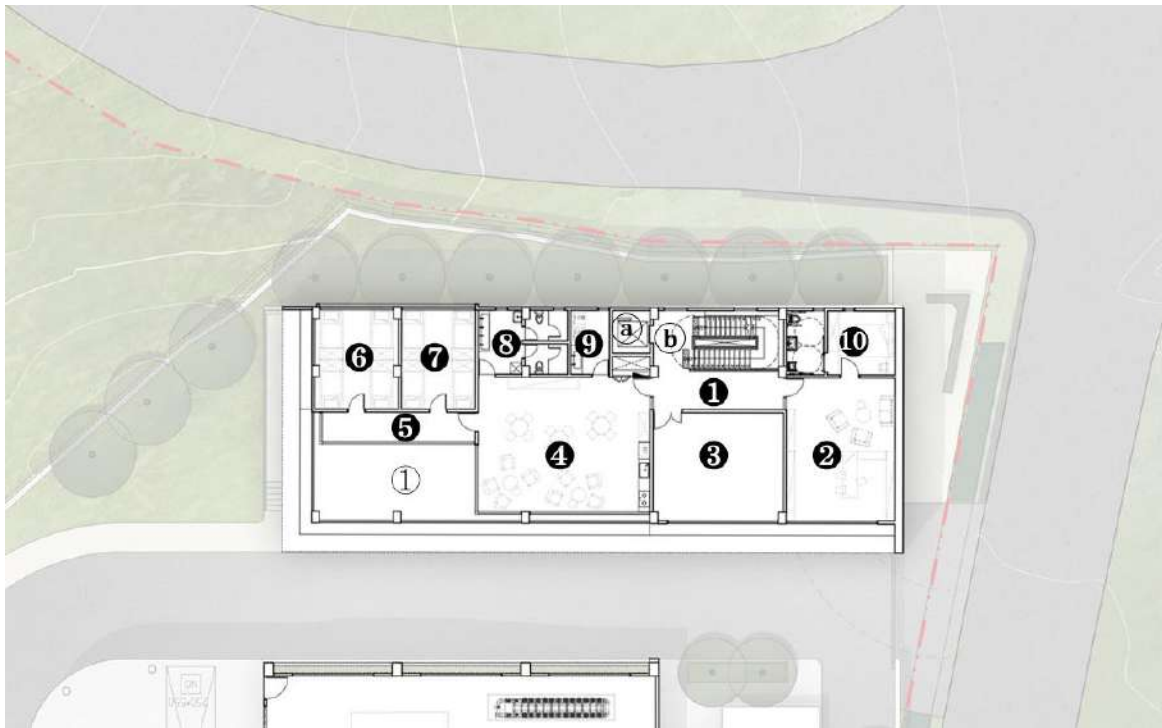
管理中心及備勤宿舍二層平面圖
